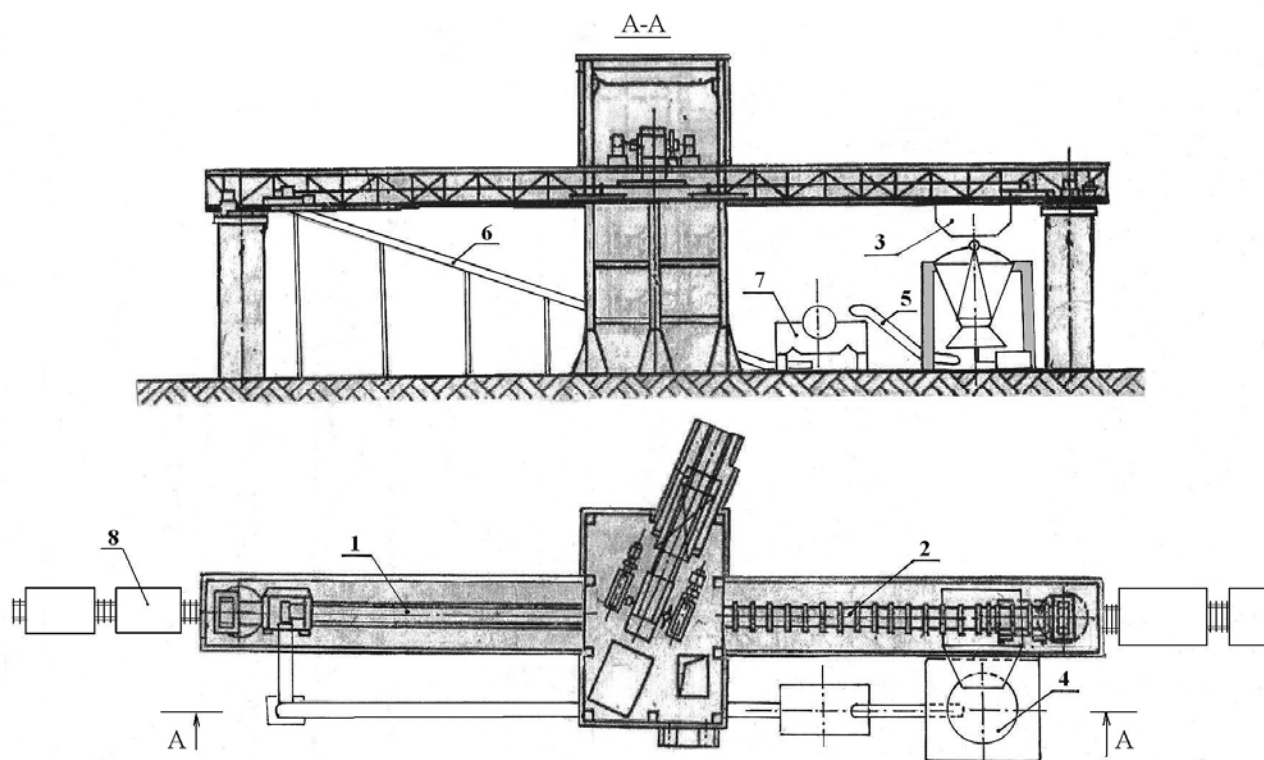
Дробильно-обогащительный перегрузочный комплекс на земной поверхности: 1 – катушечный конвейер; 2 – стационарный конвейер; 3 – бункер; 4 – дробилка среднего дробления; 5, 6 – крутонаклонный конвейер; 7 – магнитный сепаратор; 8 – думпкары
